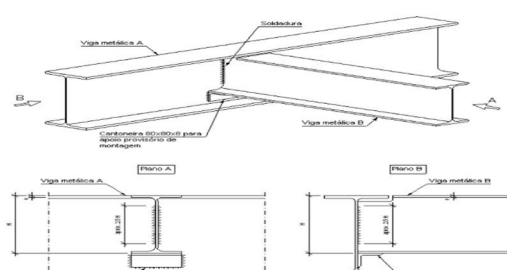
nas Ligação de vigas que vencem a compressão lajes
